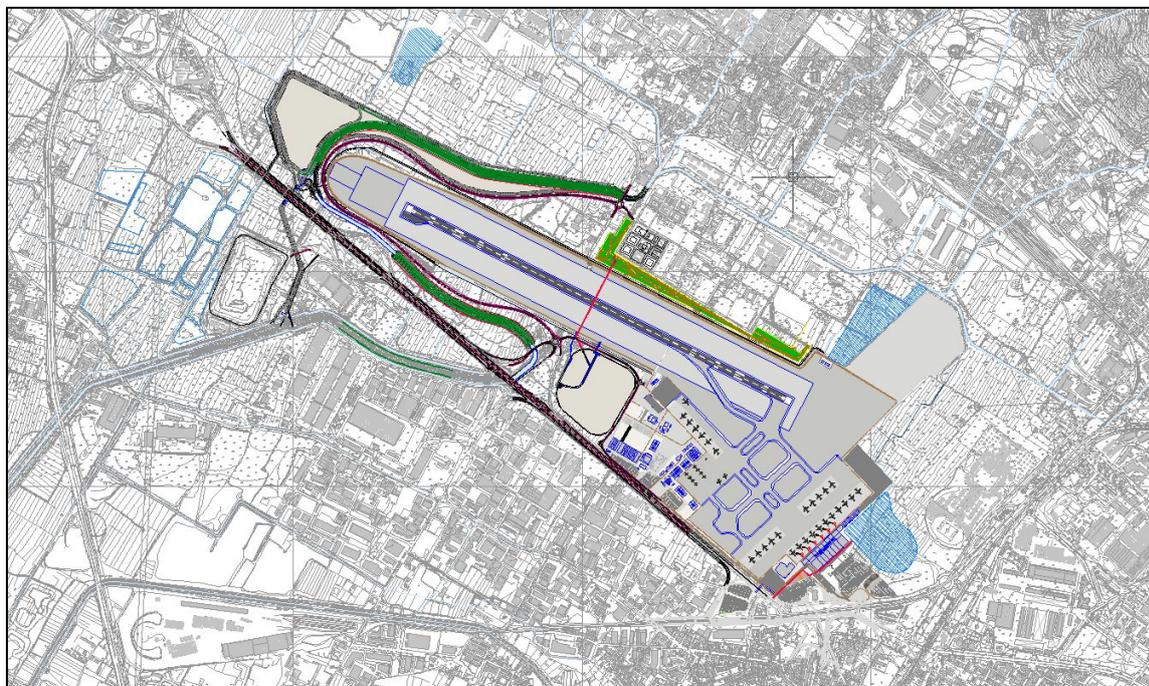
stralcio della planimetria di progetto dell'Aeroporto "Amerigo Vespucci"
